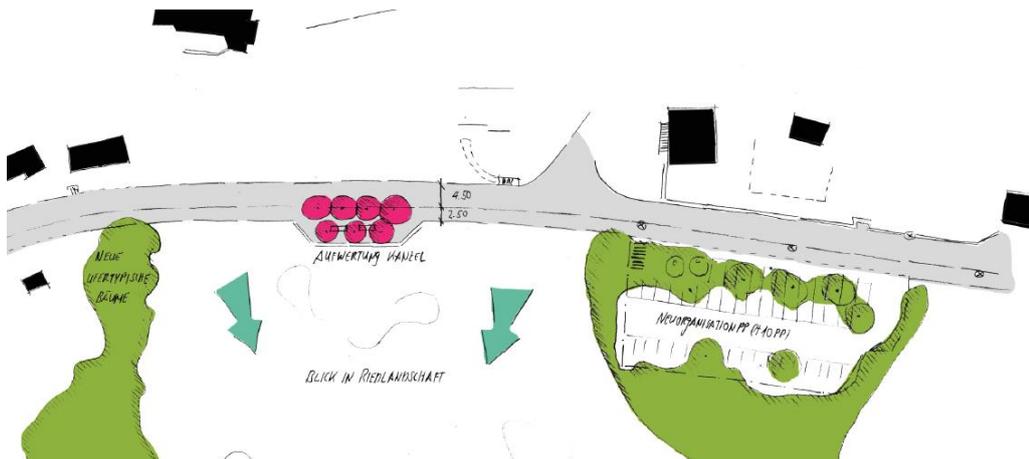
BGK Winkel- und Seestrasse, Abschnitt Ried
